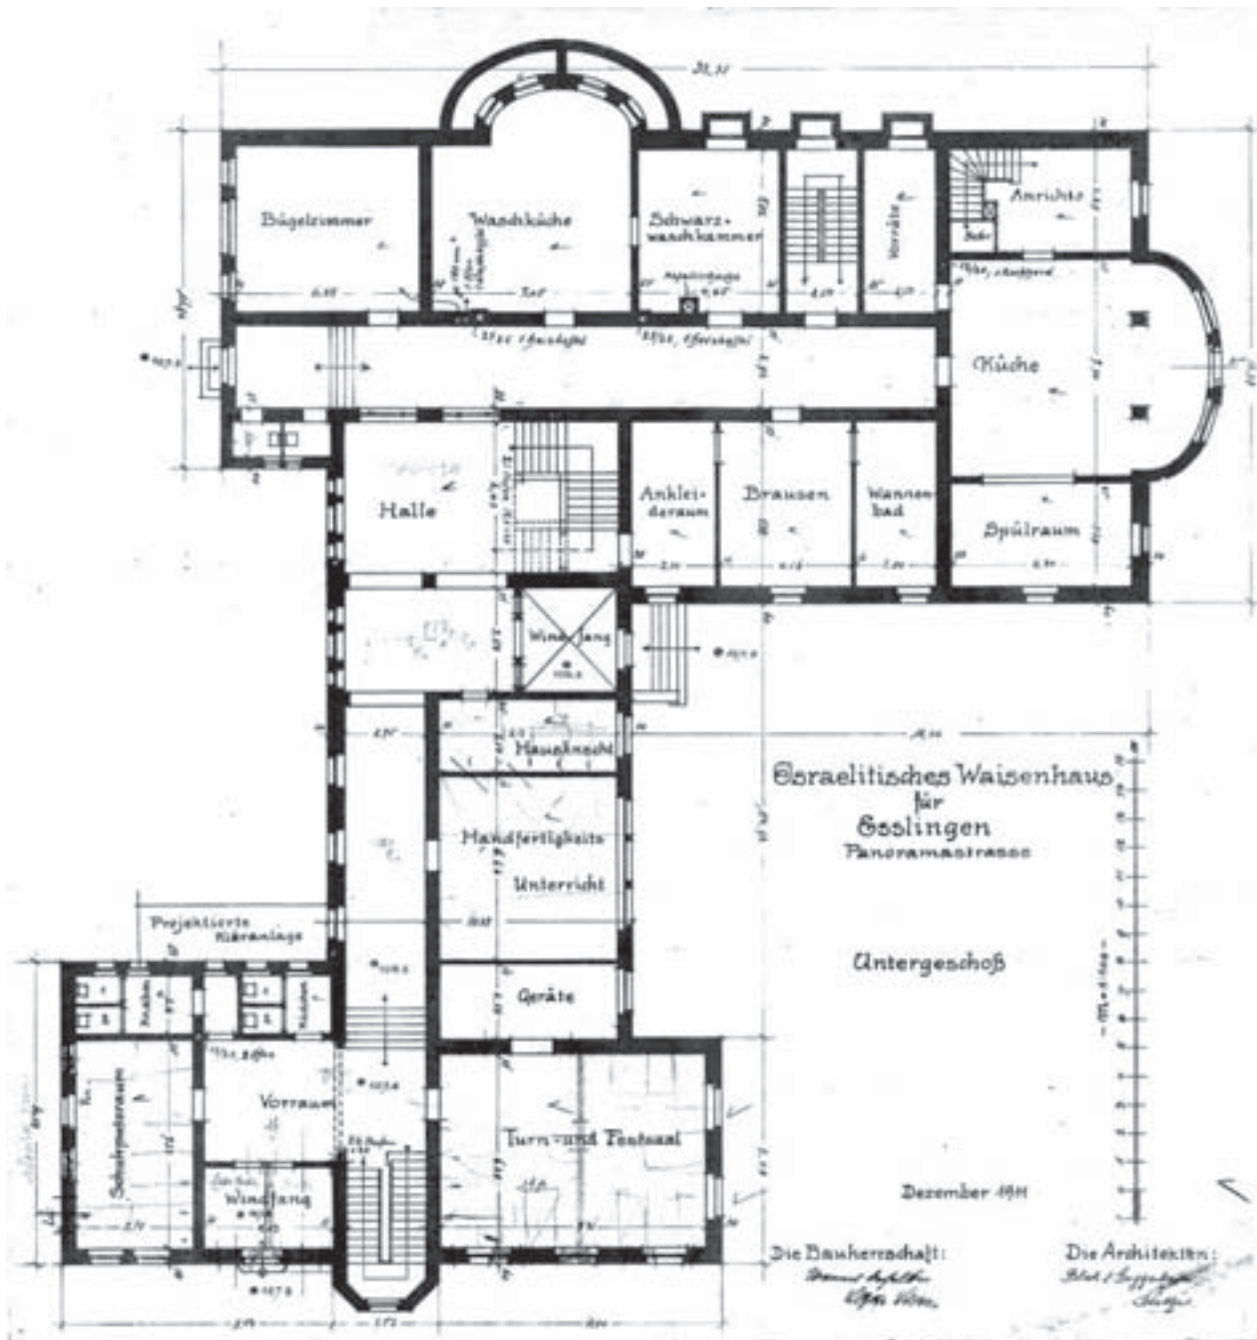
Esslingen, ehem. israelitisches Waisenhaus Wilhelmspflege, Grundriss Untergeschoß (Sockelgeschoss), 1911 [bearb.]; BRA ES
